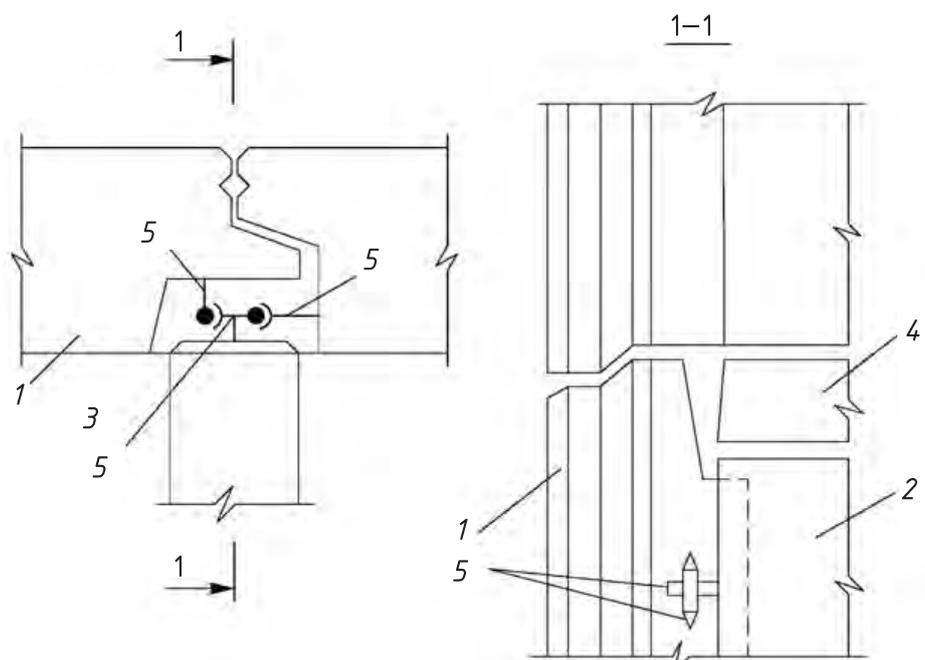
Конструкция связей самофиксирующаяся замкового типа: 1 — панель наружной стены; 2 — панель внутренней стены; 3 — бетон замоноличивания; 4 — панель перекрытия; 5 — закладные связи самофиксации
